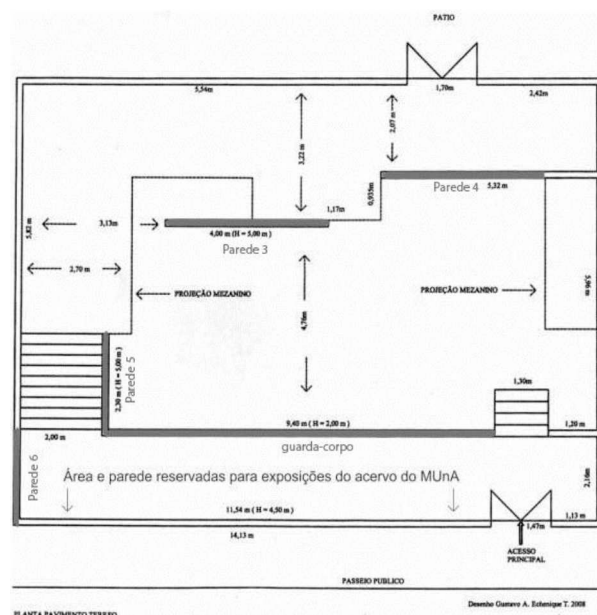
Planta baixa com destaque da posição dos suportes em cinza.
